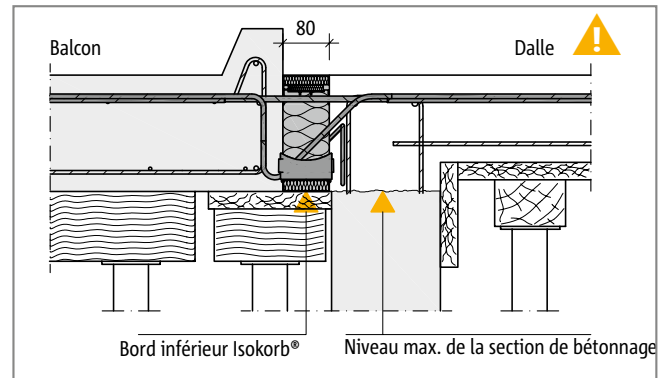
Schöck Isokorb® T Type K-E, K-T : Balcon préfabriqué complet avec plancher décalé en hauteur sur mur en béton
